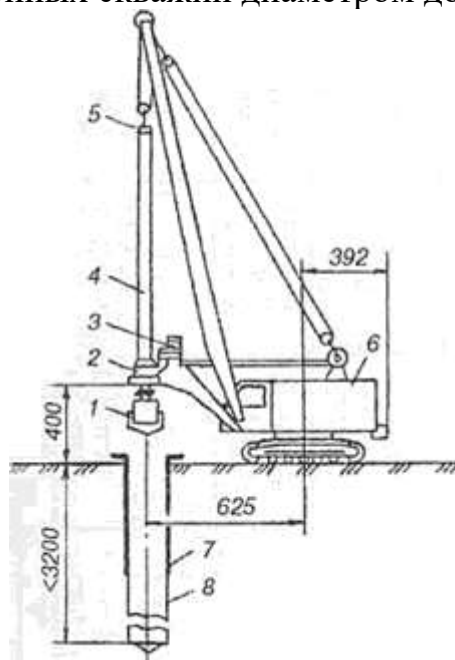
Навесное оборудование МБУ-1,2 на кране:
